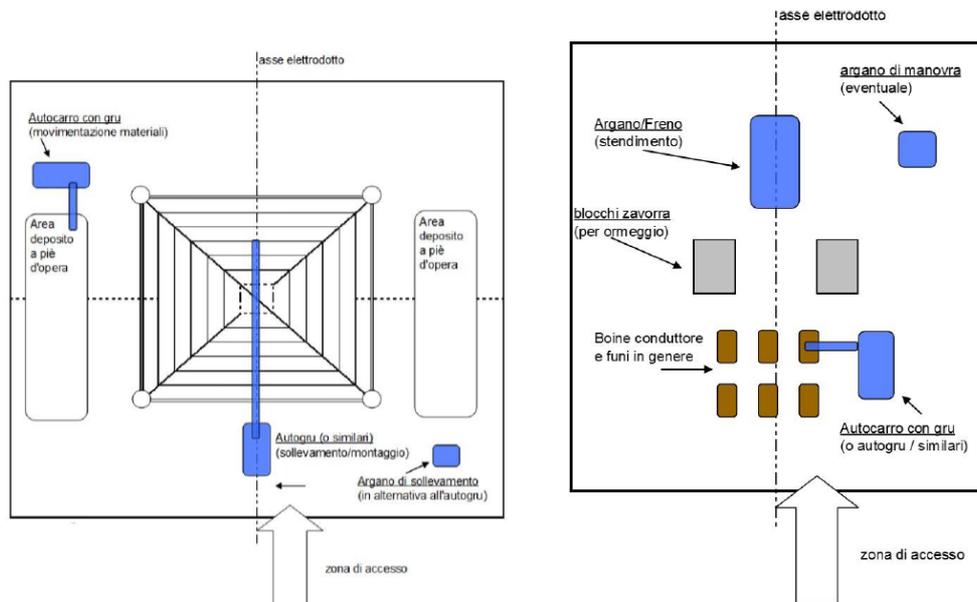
Planimetria dell’Area microcantiere (montaggio sostegno), a sinistra e Planimetria dell’Area di linea -Tipologico, a destra
